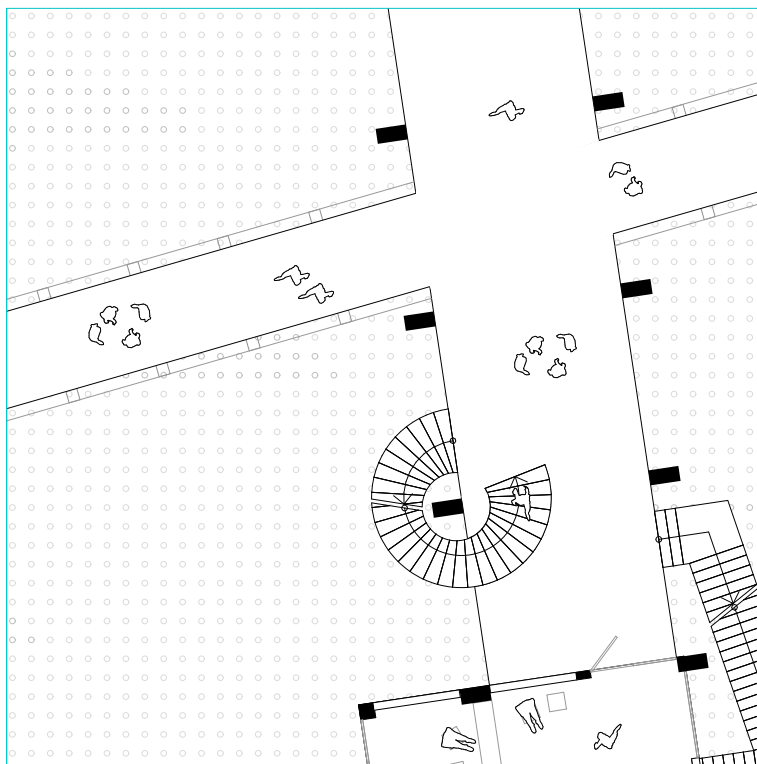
Ausschnitt Grundriss 3. Ebene 1:200
